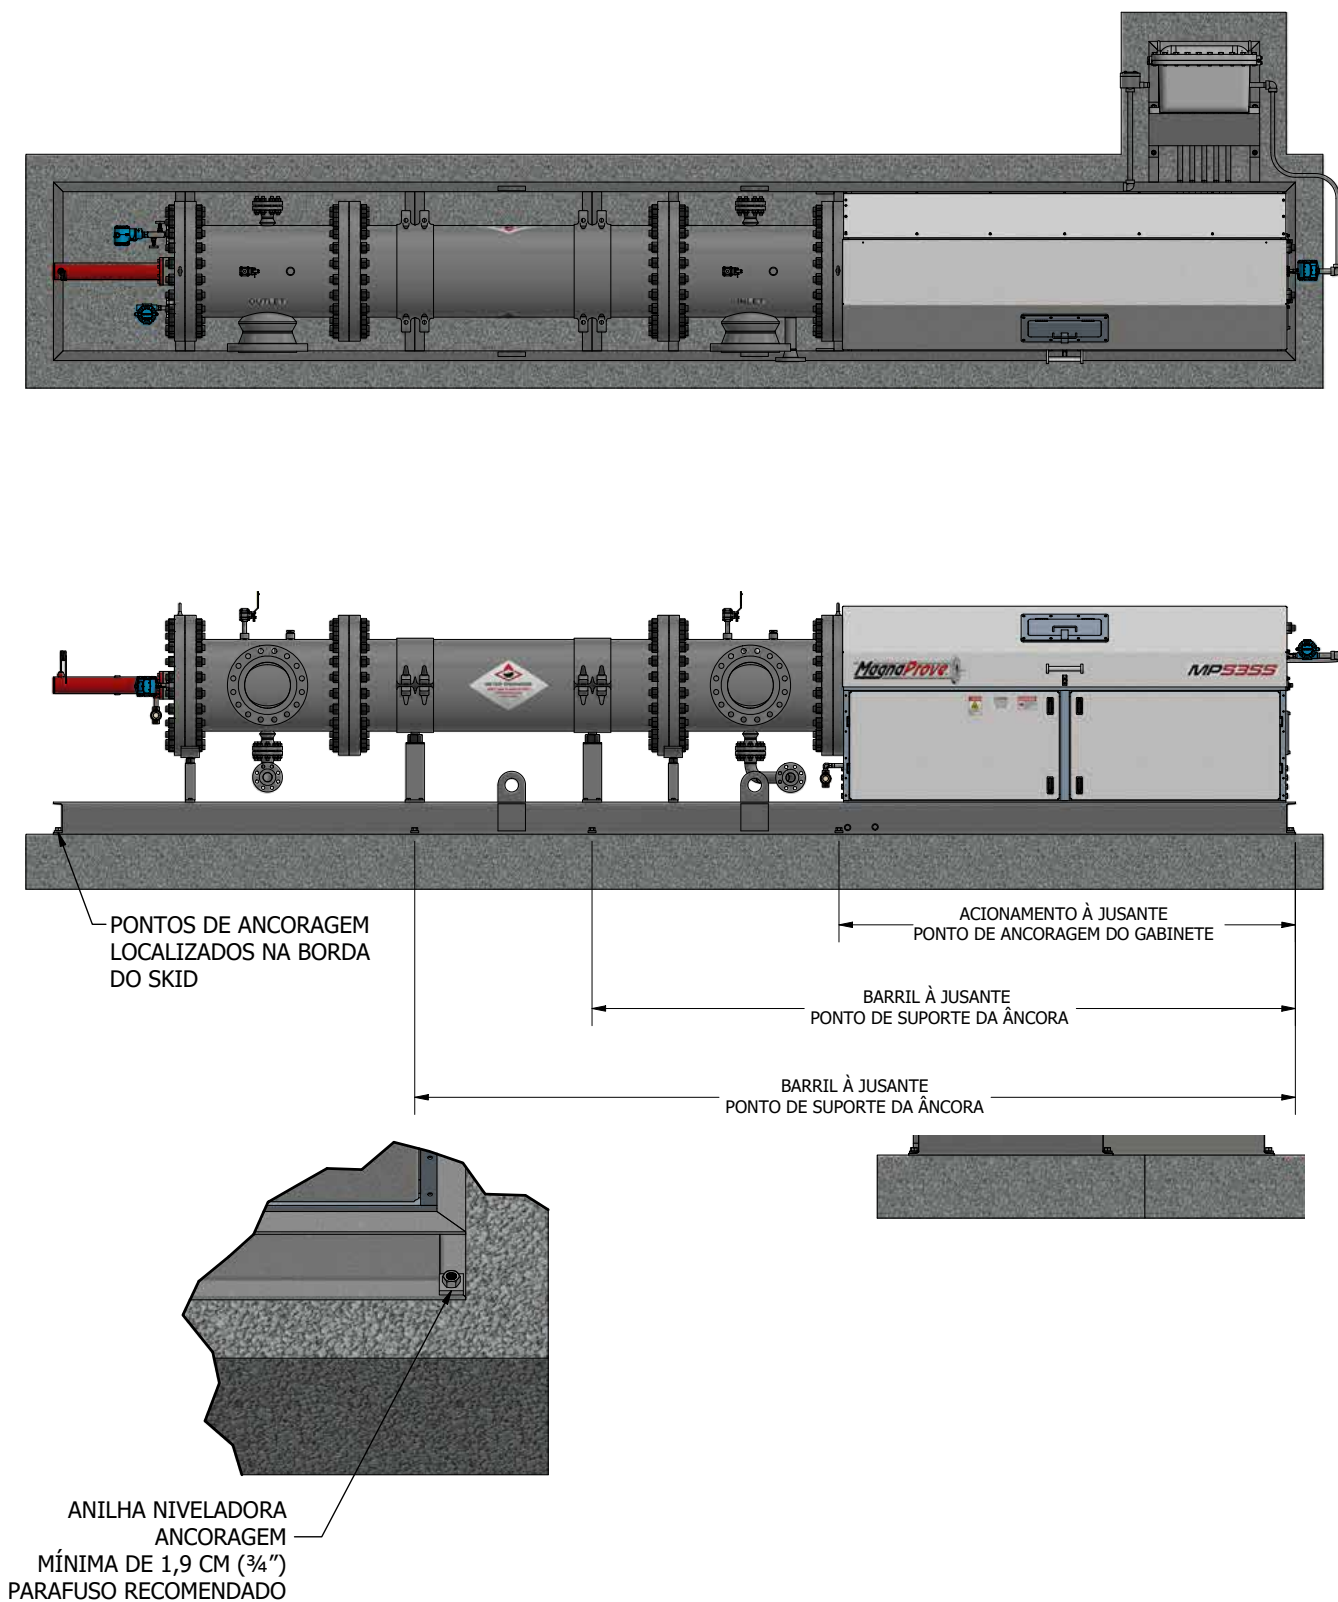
B - Instruções de localização do ponto de ancoragem da laje
